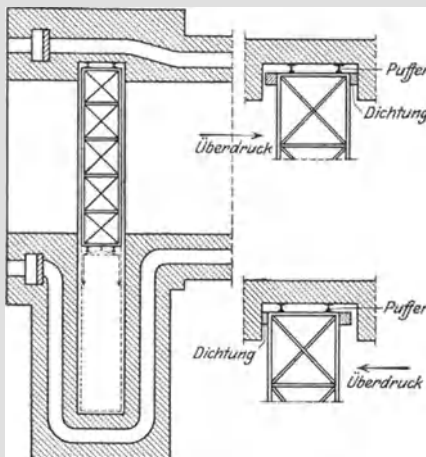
Doppelkehrendes Schiebetor (Ponton).
